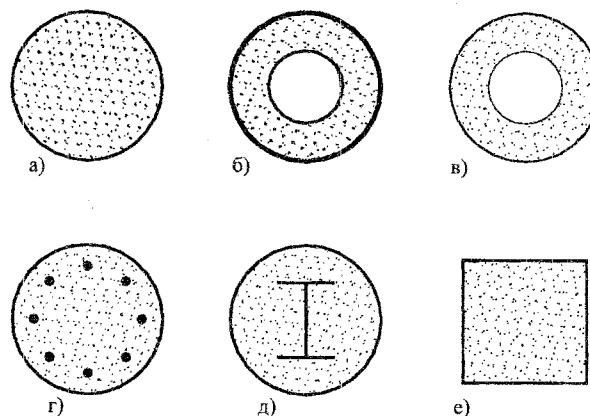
Характерні перерізи трубобетонних елементів:
